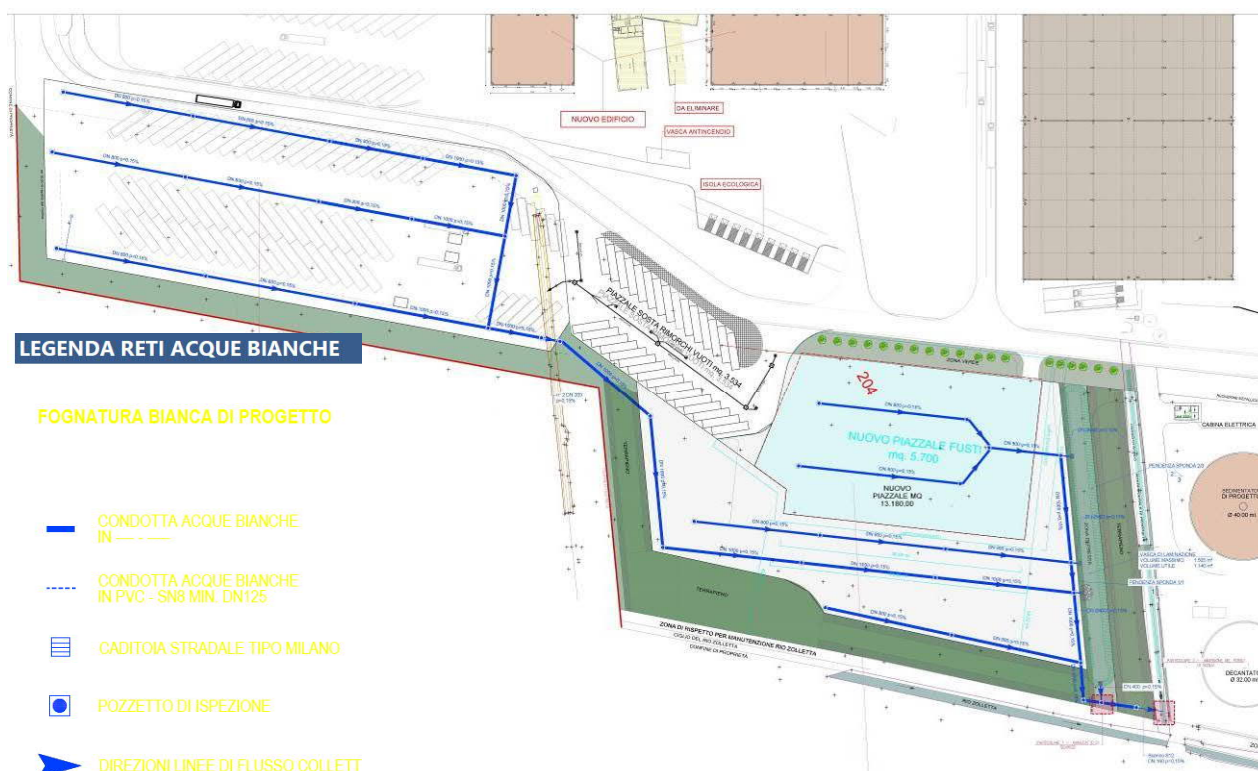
Estratto della Planimetria opere idrauliche-Rete bianche e particolari costruttivi (Fonte: geom. Aldo Trombi)
